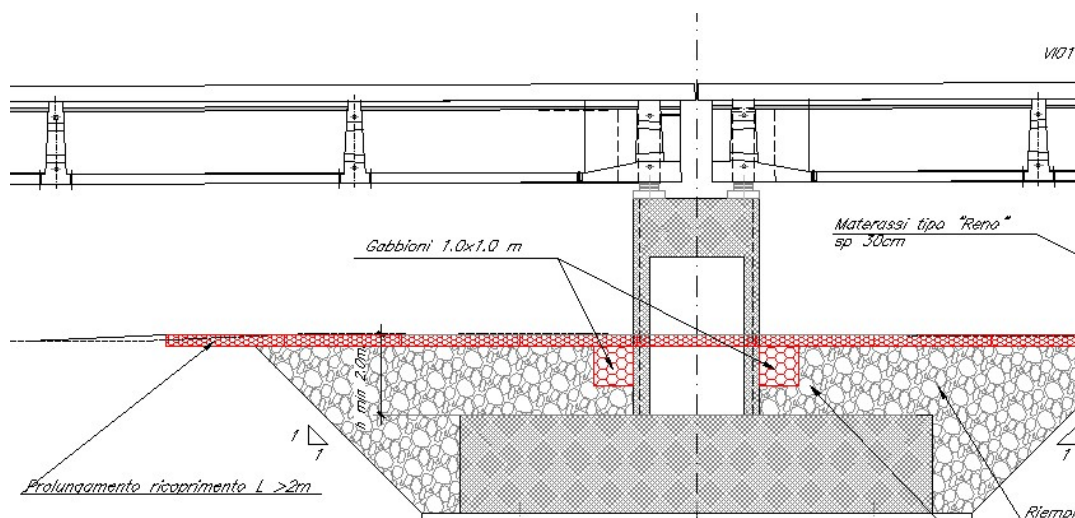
Protezioni al piede delle pile, sezione longitudinale del viadotto.
